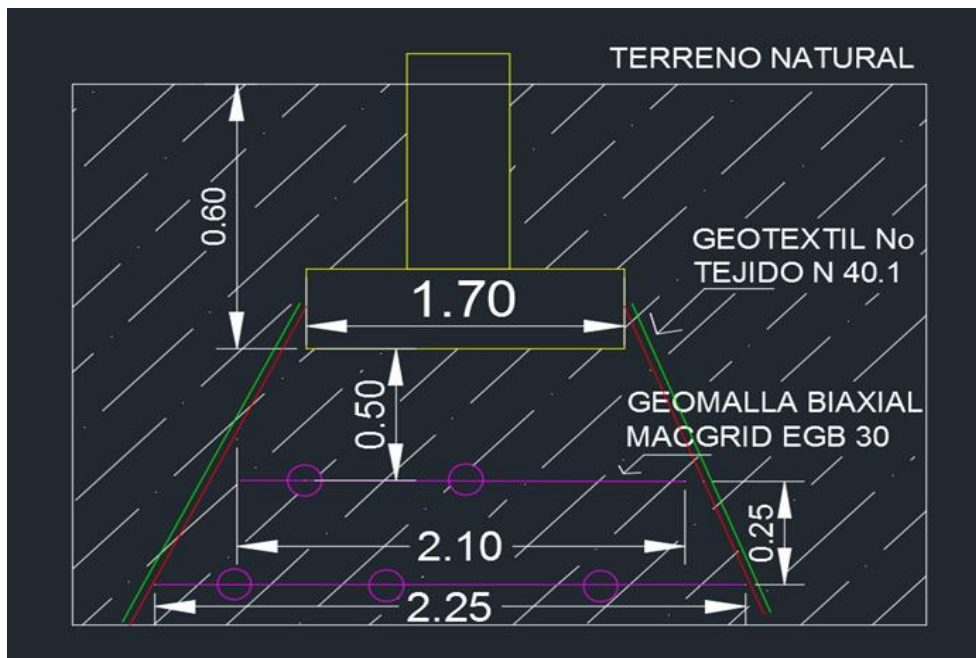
Diseño de cimentación con refuerzo de geomallas para zapata N°3
